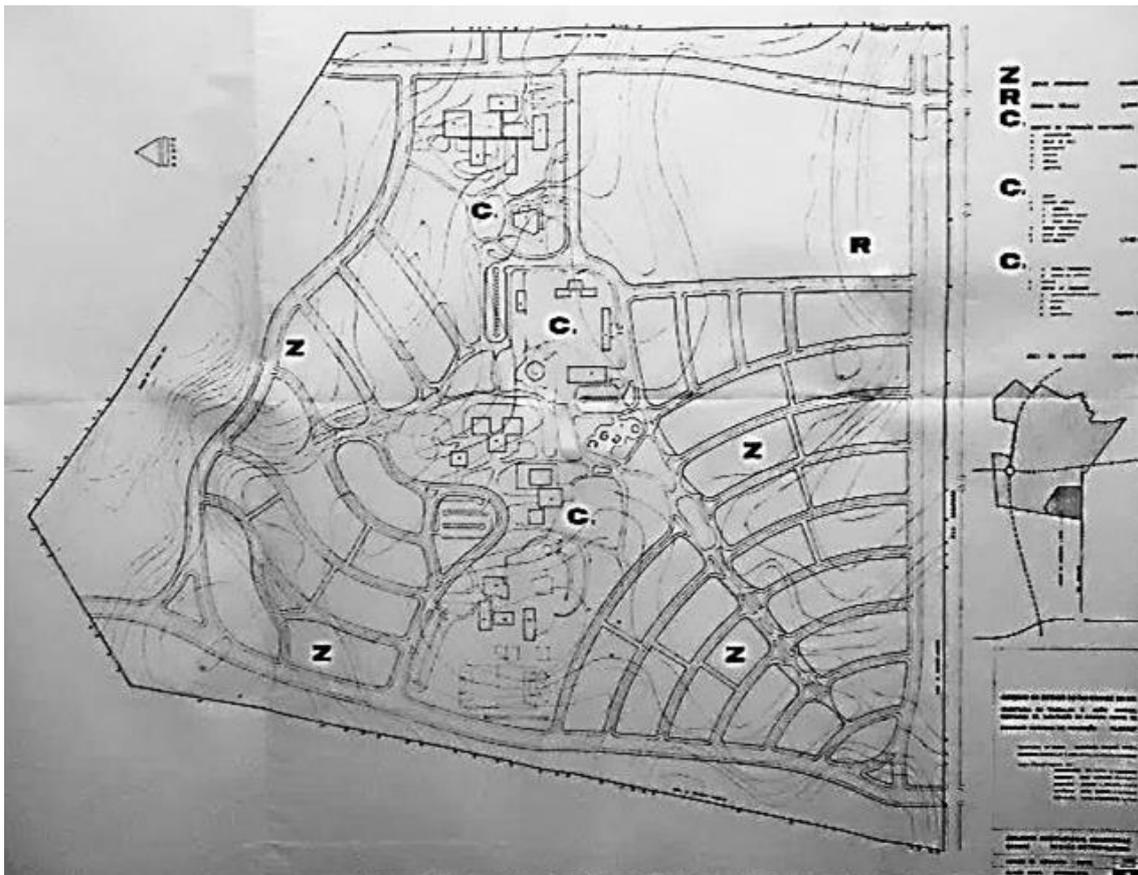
Planta geral da Unidade de Vizinhança nº1 Oeste.
